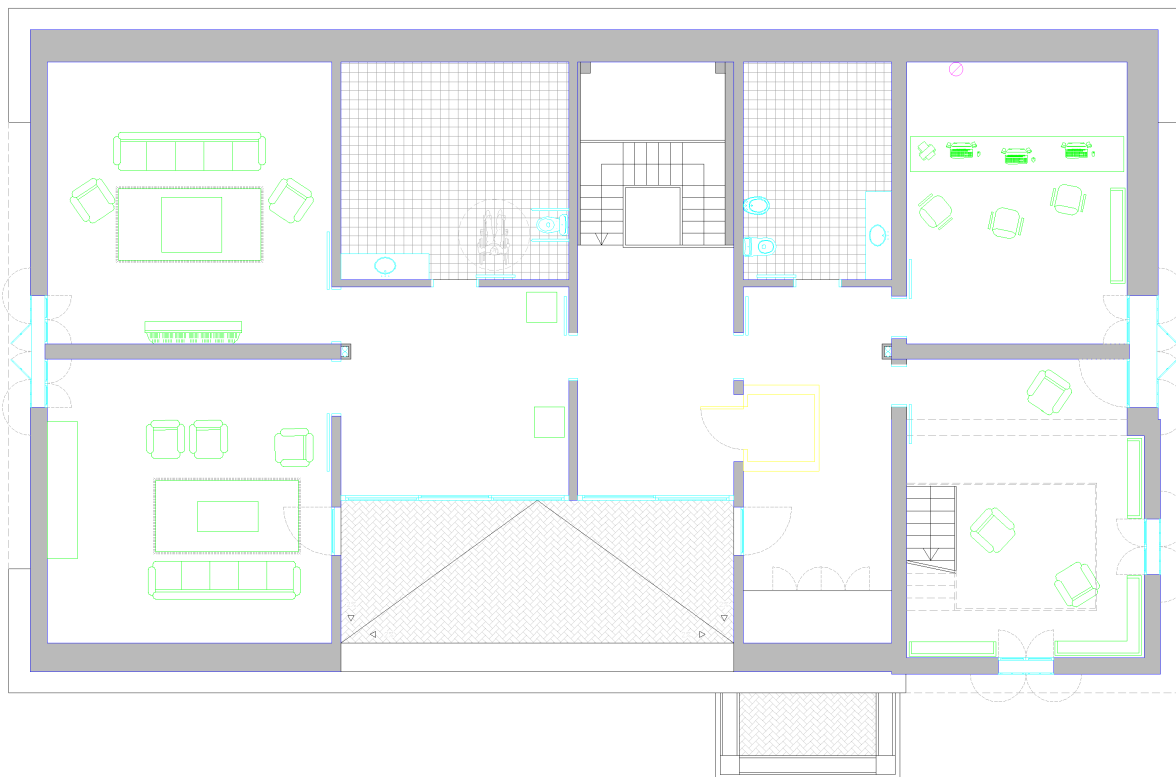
Plano planta segunda (Fuente: Propia)
